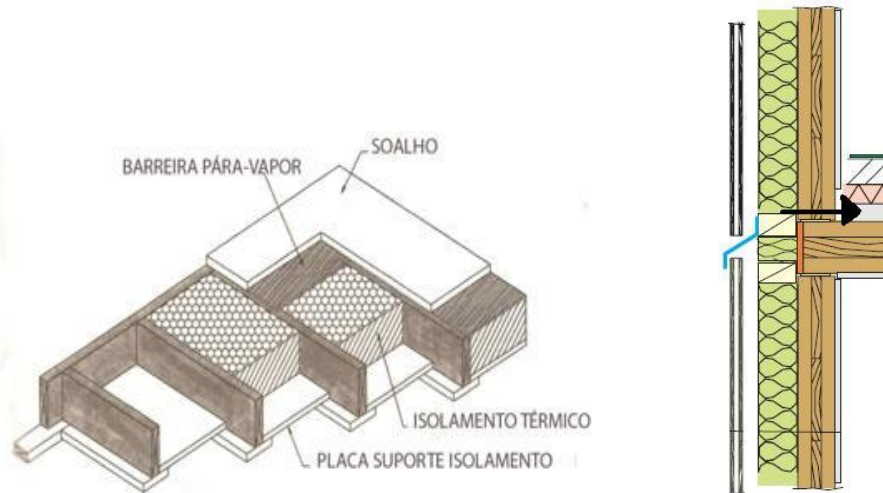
Pormenor pavimento [2] e camada de isolamento acústico [22]
